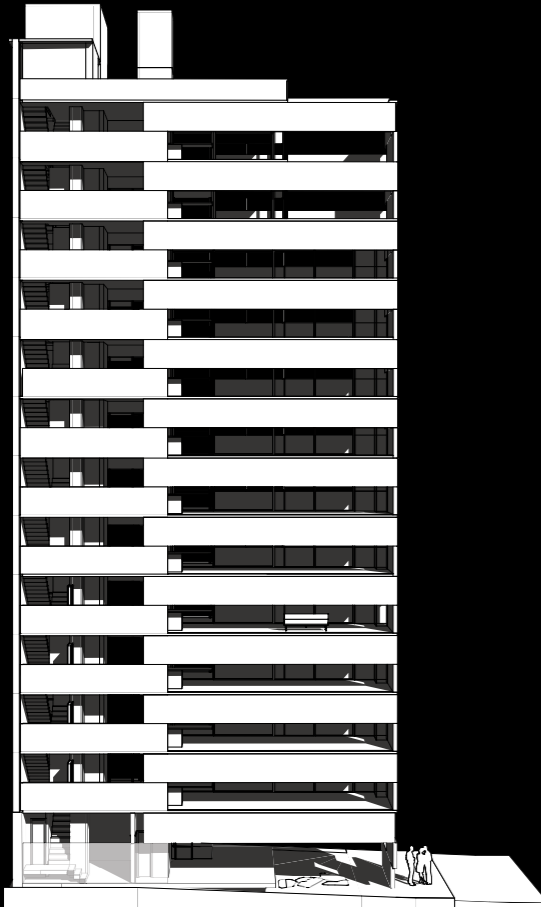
Elaboración Propia PERSPECTIVA ISOMETRICA FACHADA LINDERA OESTE SISTEMA ESTRUCTURAL
